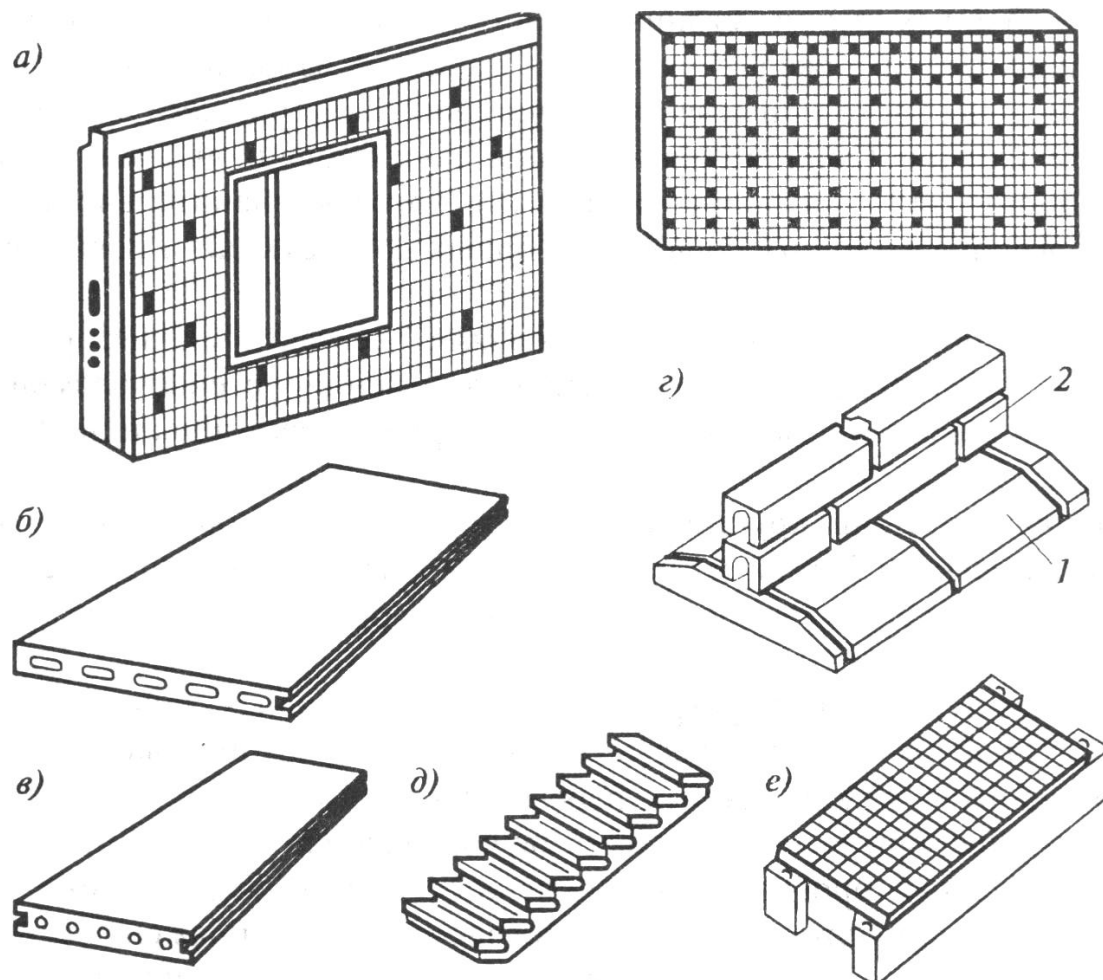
Некоторые виды сборных железобетонных изделий:
